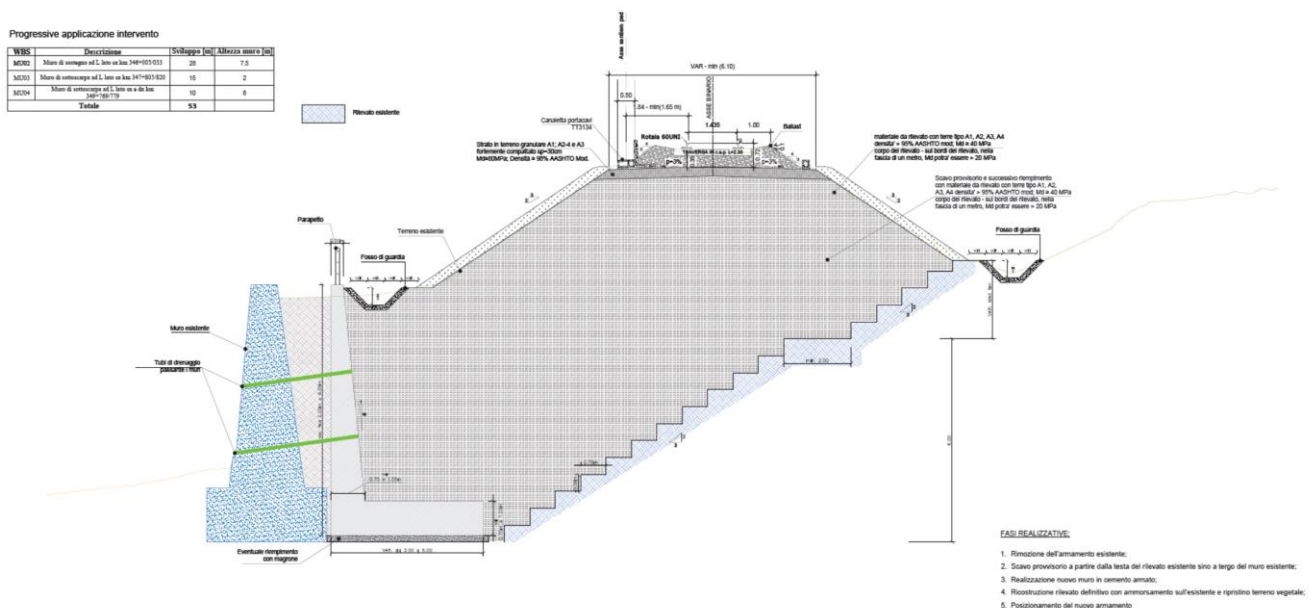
Sezione tipologica 1 – Muro a L (Doc. Rif. [2])
